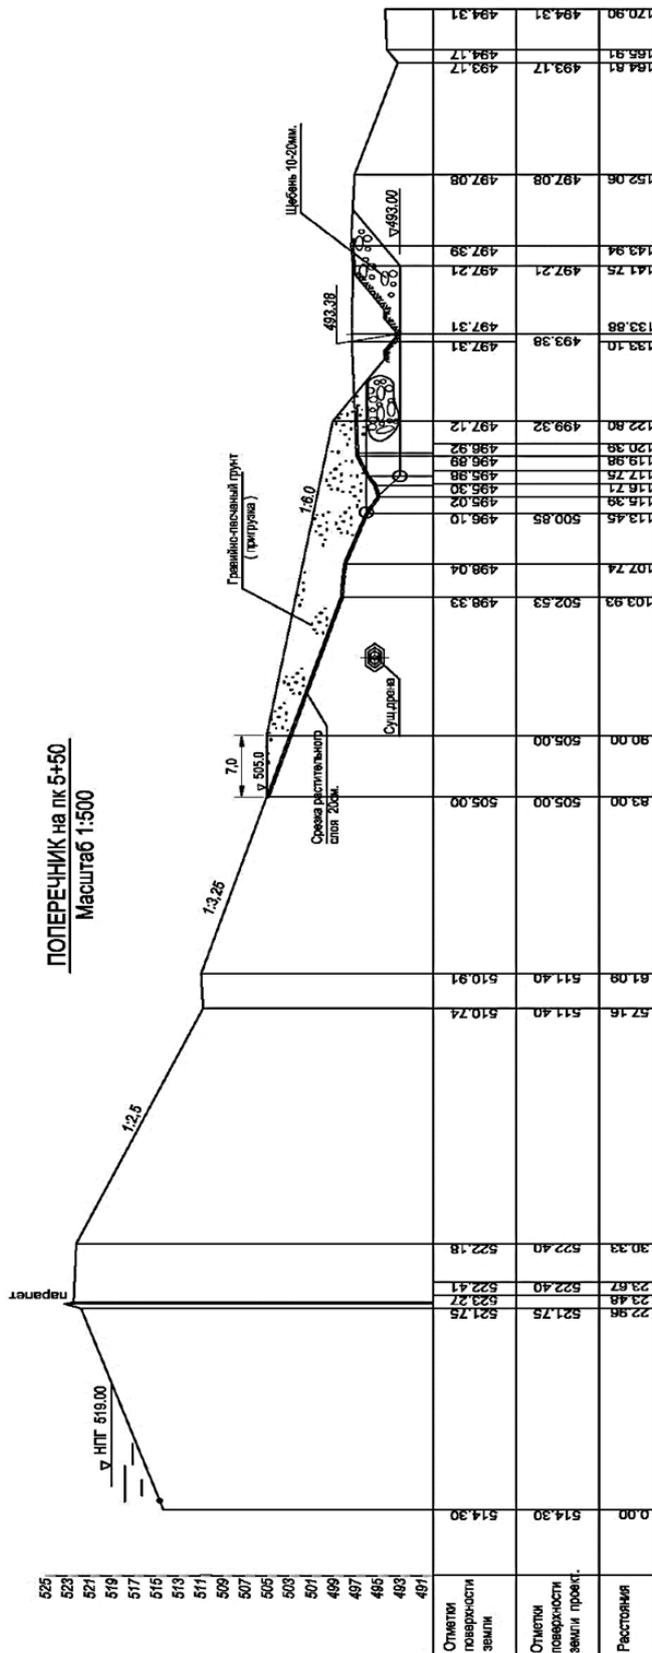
Поперечное (проектное)сечение плотины Тасоткельского водохранилища после пригрузки низового откоса.
